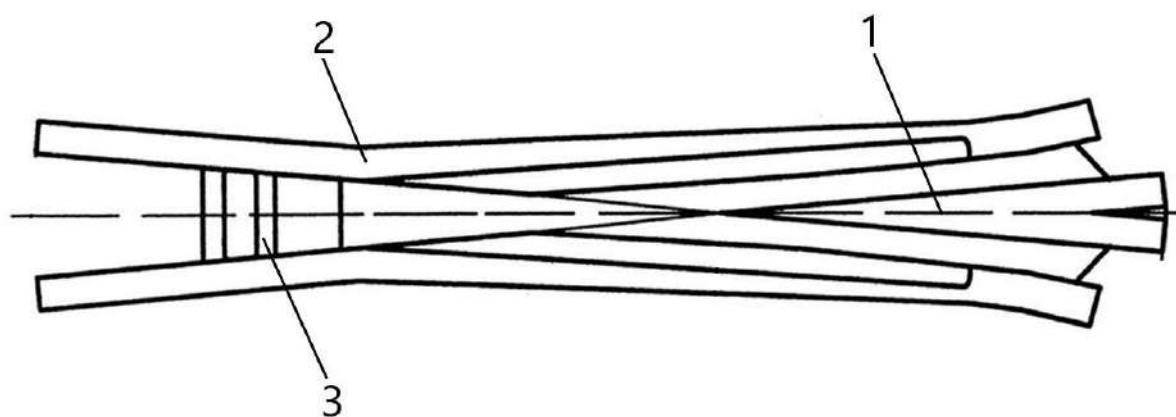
Конструкции крестовин с непрерывной поверхностью катания для особо грузонапряженных участков пути
